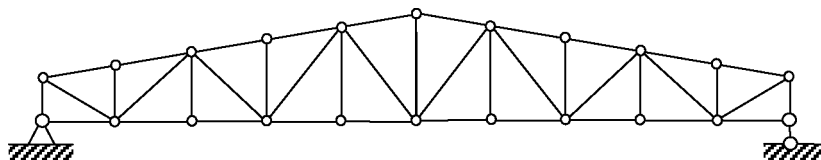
Двухскатная ферма с треугольной решеткой и дополнительными стойками
